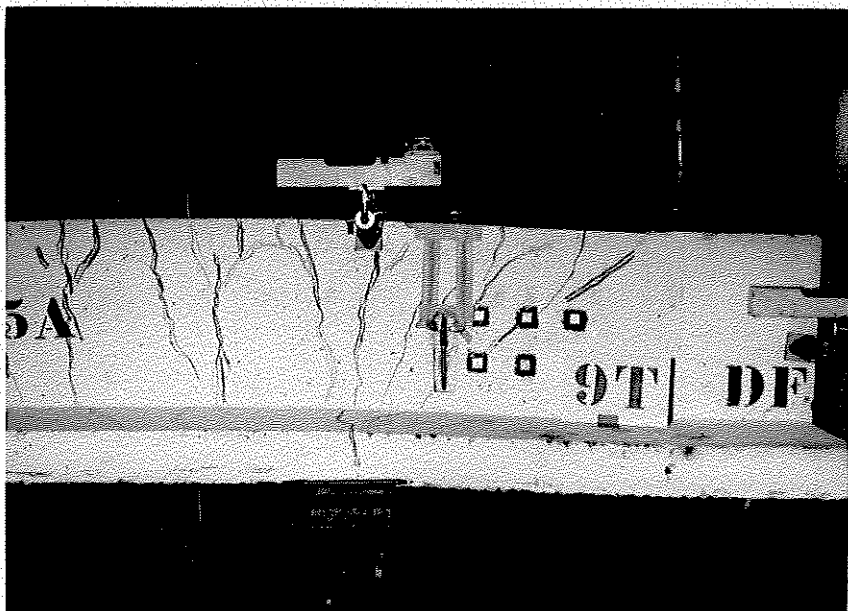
Lado direito da viga V15A. Armadura transversal em escoamento.
